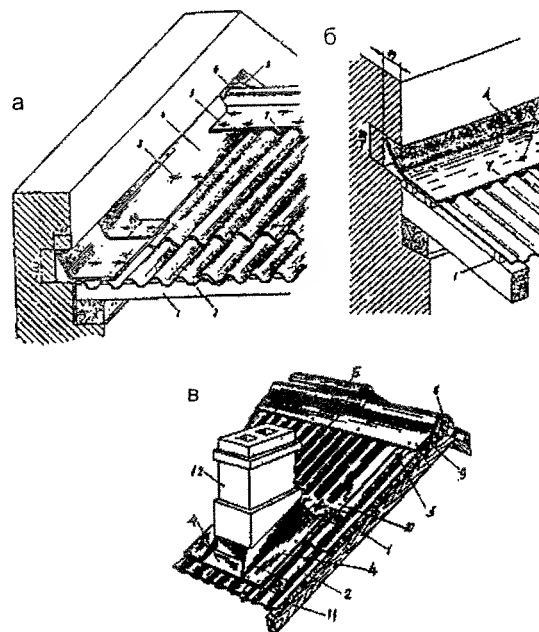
Конструкция примыкания кровли из асбестоцементных волнистых листов к продольной (а) и поперечной (б) стене и устройство воротника дымовой трубы (в)
